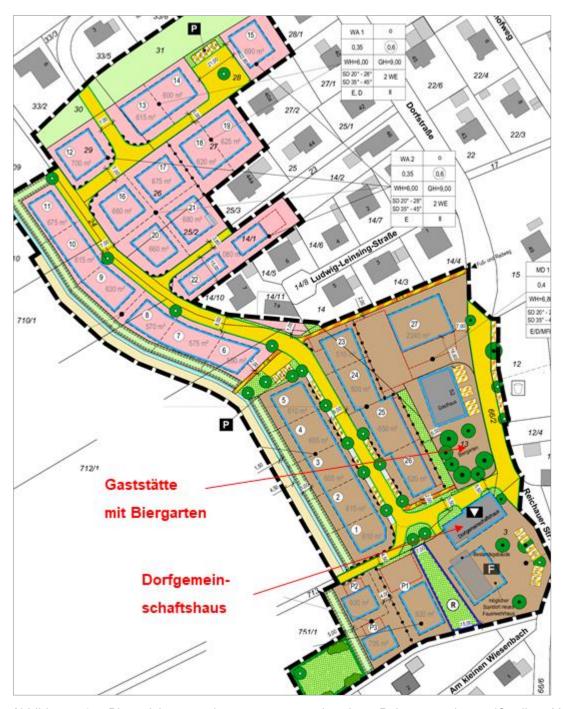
Planzeichnung des zu untersuchenden Bebauungsplans (Quelle: Vorentwurf Bebauungsplan [9])
